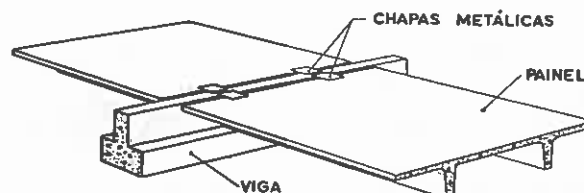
Apoio de painéis TT sobre vigas (3)
